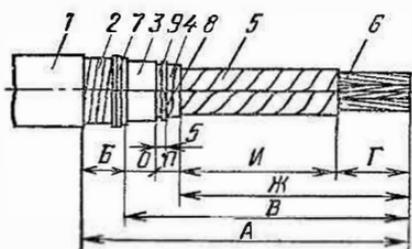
Разделка конца трехжильного кабеля с поясной бумажной изоляцией:
